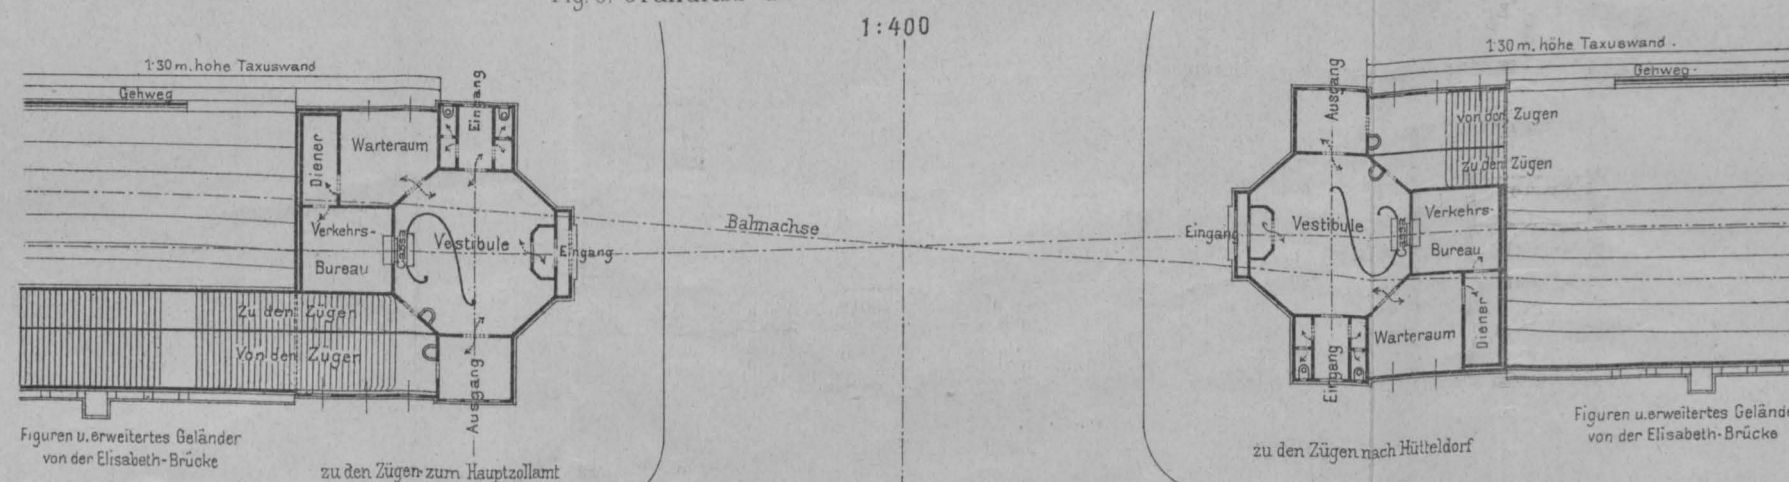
Grundriss der Haltestelle Akademiestrasse.
